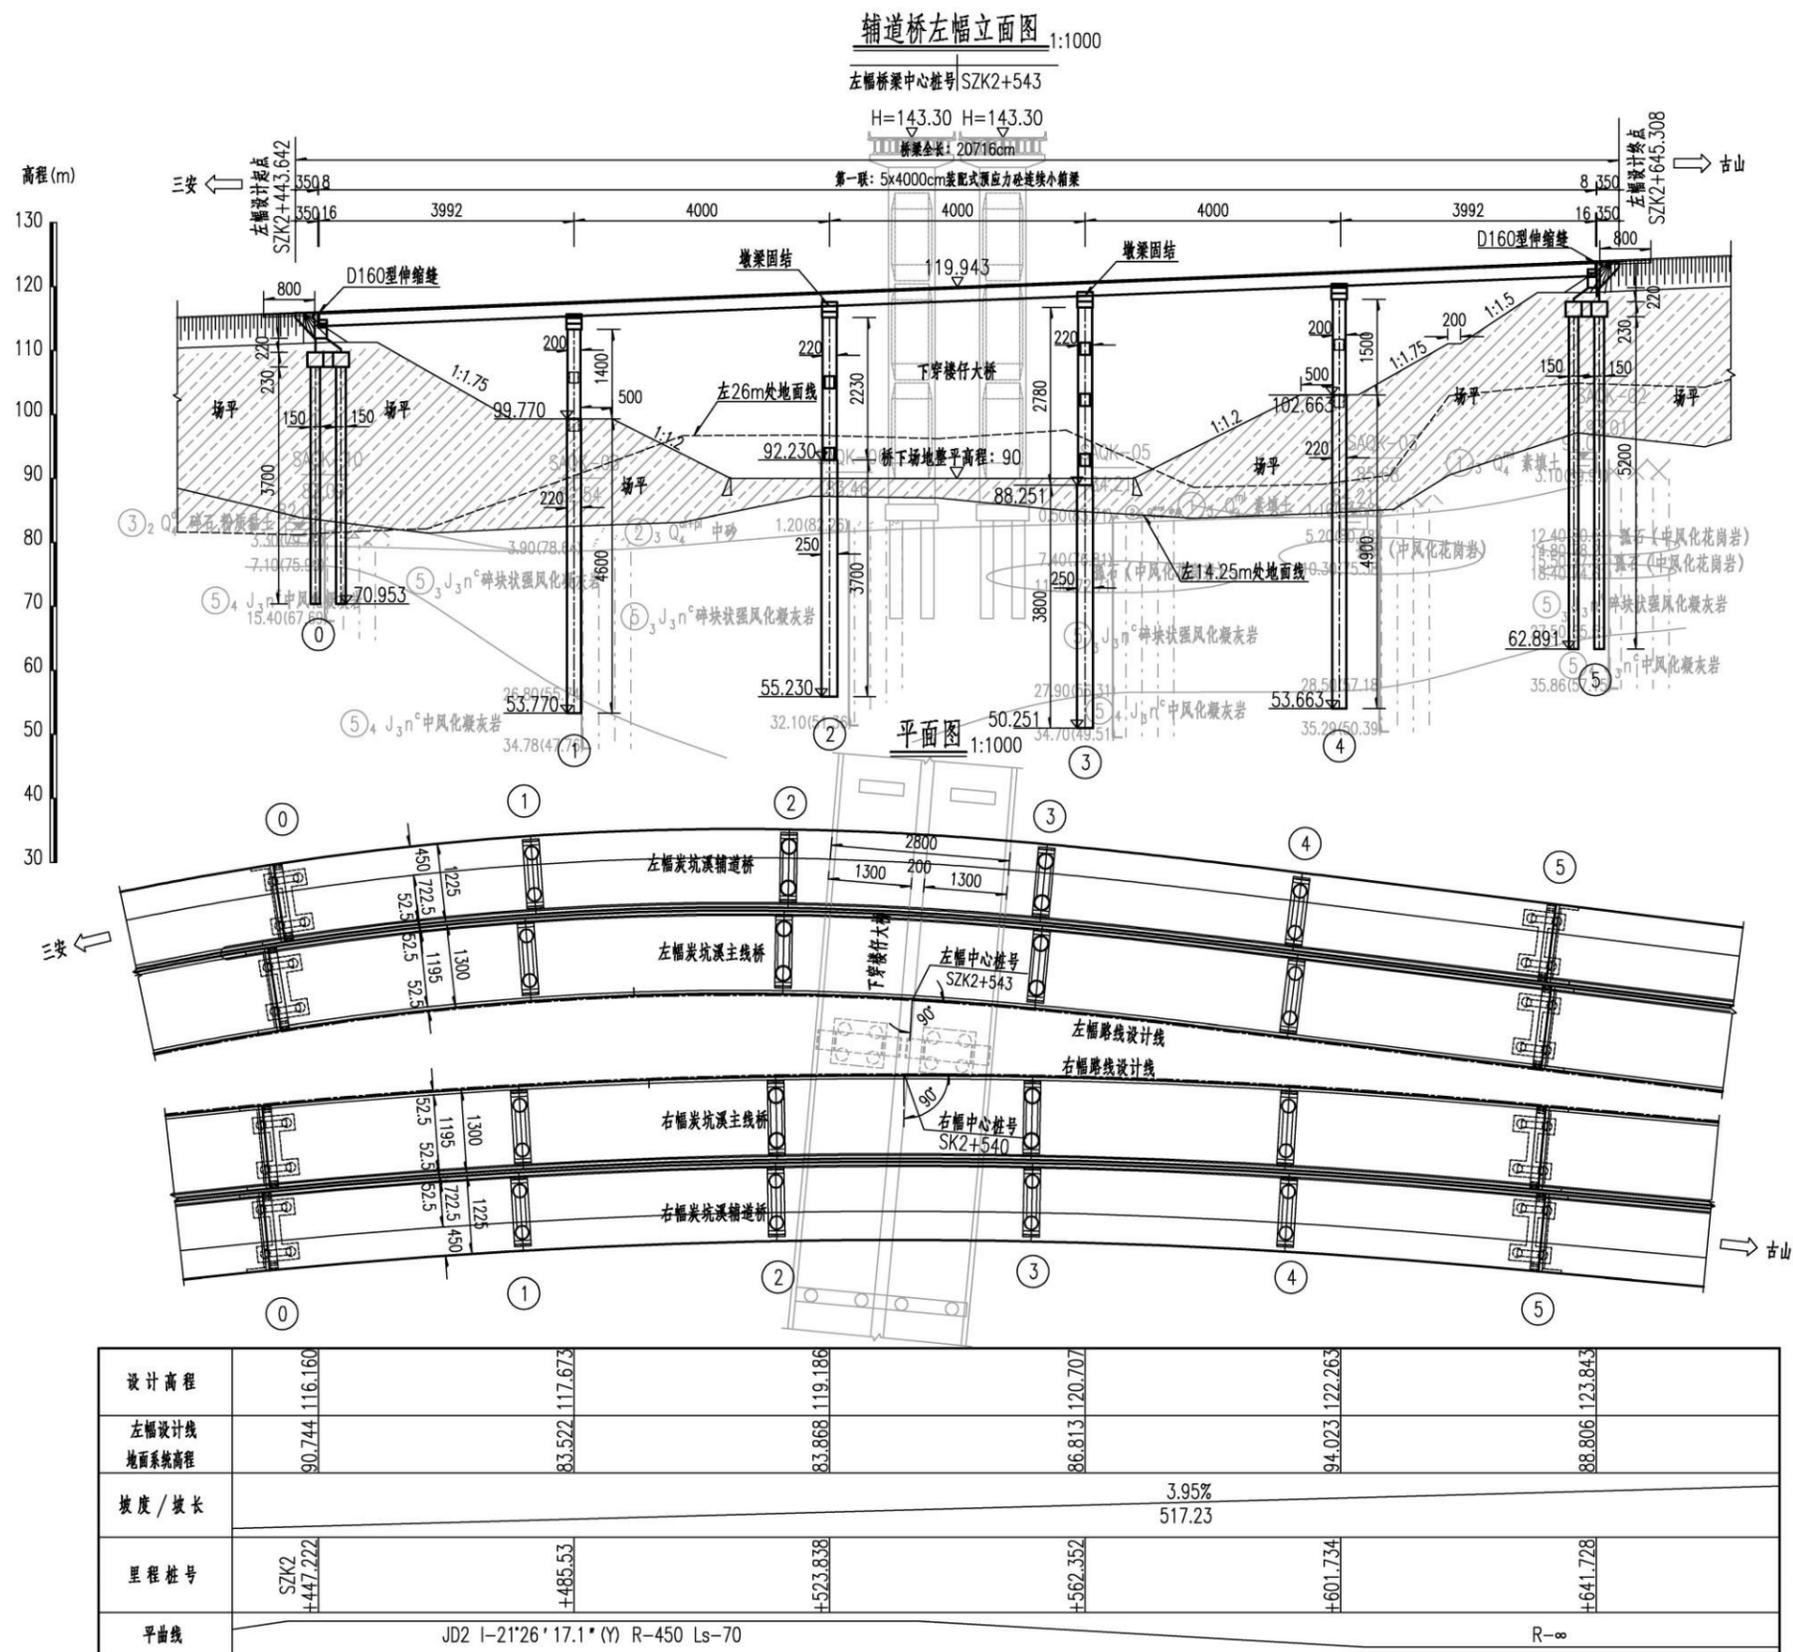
本项目炭坑溪大桥辅道桥左幅立面图
